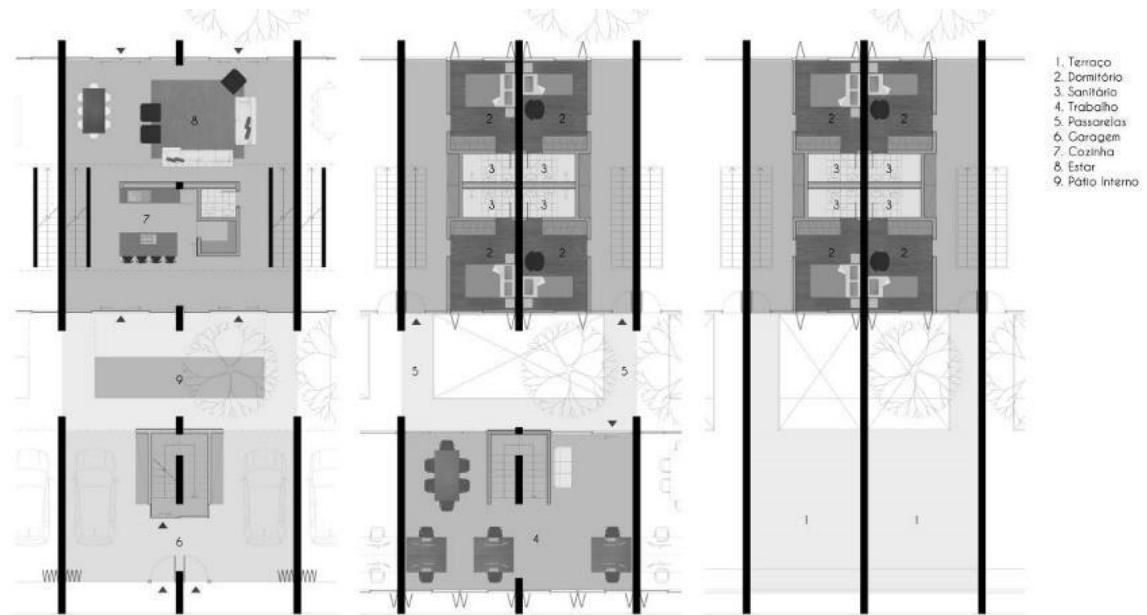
plantas do Conjunto Habitação + Trabalho, da esquerda para direita: 1º, 2º e 3º pavimento, respectivamente, legenda à direita. Fonte: autor.
